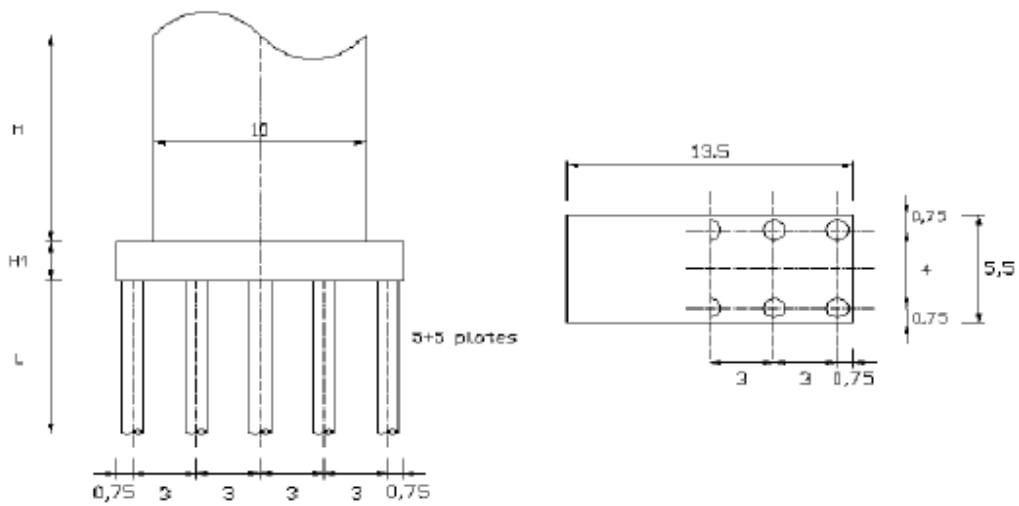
Corte transversal y vista en planta de los pilotes del viaducto El Salto, dimensiones en [m] (Daza, 2003)
